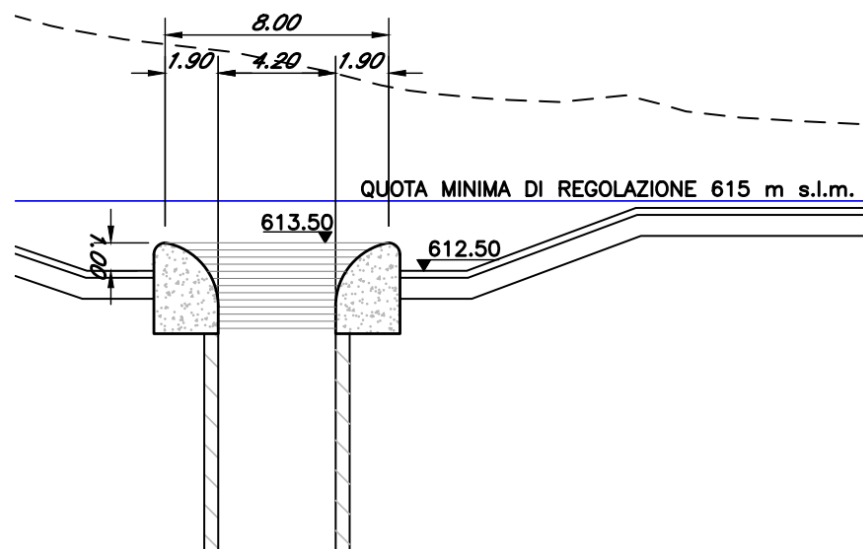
Sezione longitudinale dell'opera di presa e restituzione di monte
